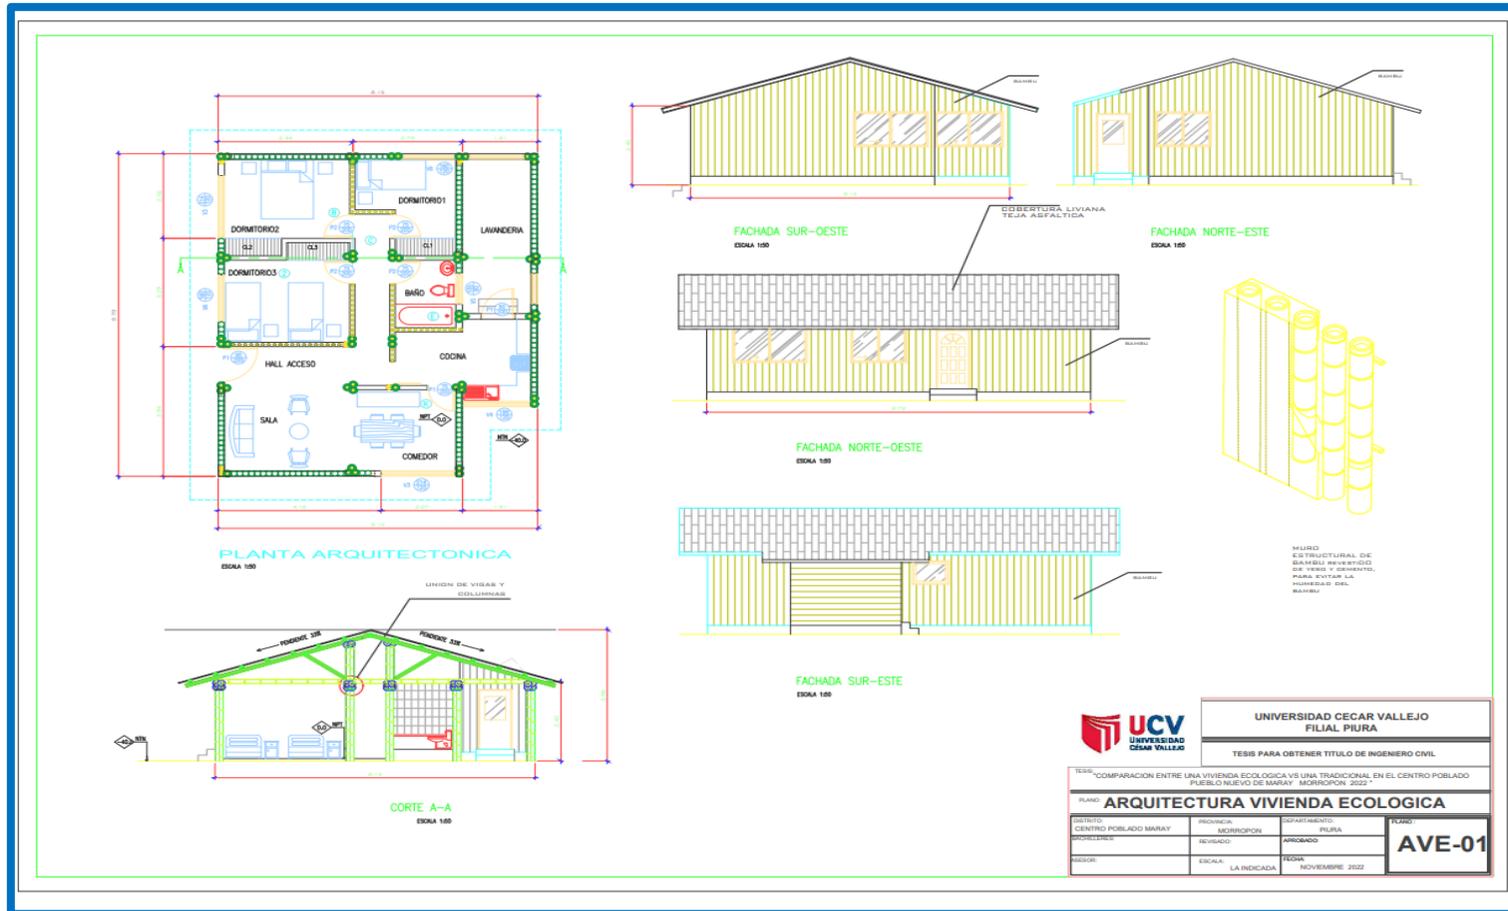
Plano de arquitectura – vivienda ecológica (AVE – 01)
